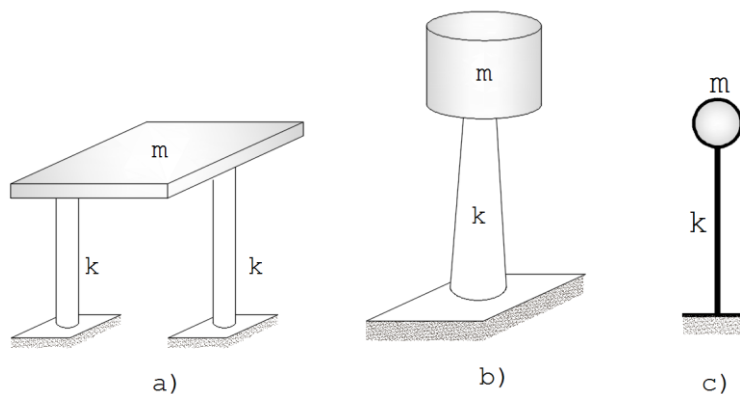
Estructuras simples, a) pérgola, b) tanque elevado, c) estructura idealizada
